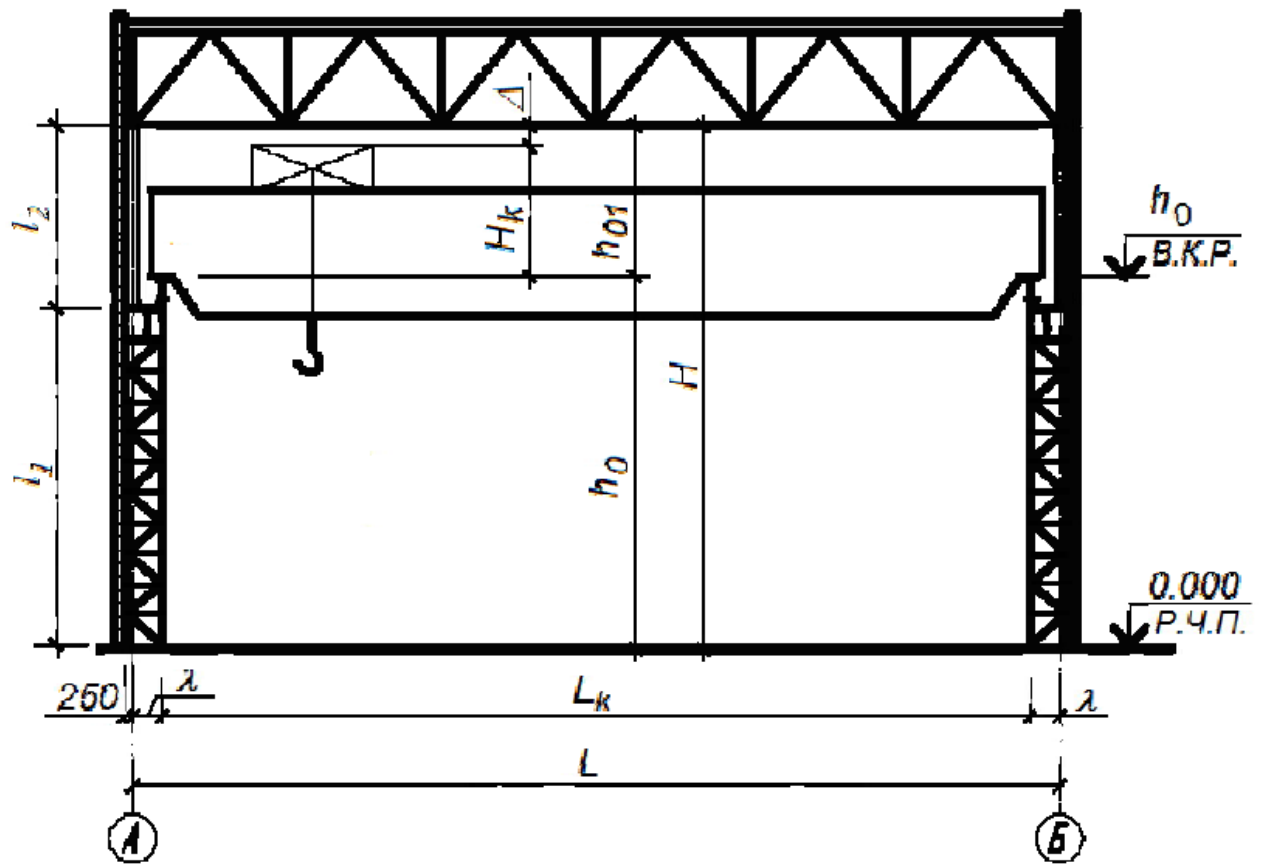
Схема поперечного перерізу виробничої будівлі
